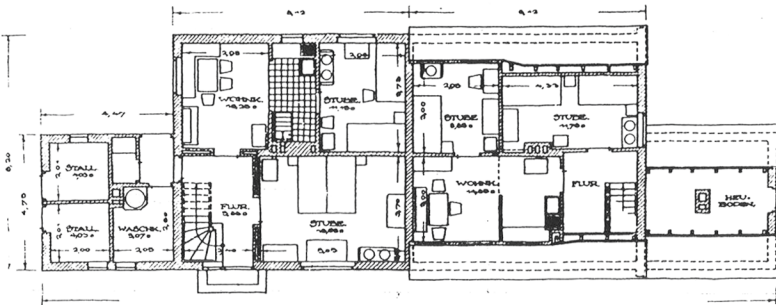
Typ Mülls Erd- und Obergehoß M. 1:200.
